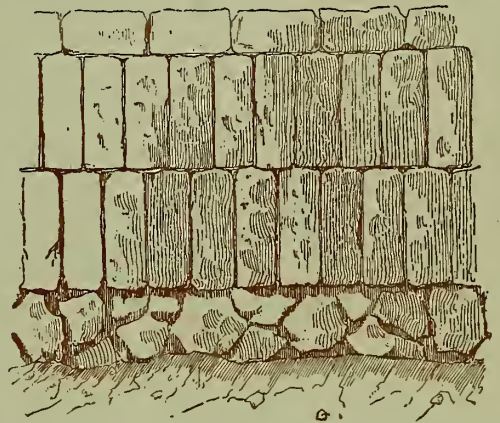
ESTRUCTURA DEL MURO DE UNA TORRE EN KHORSABAD (SEGÚN LAYARD)
